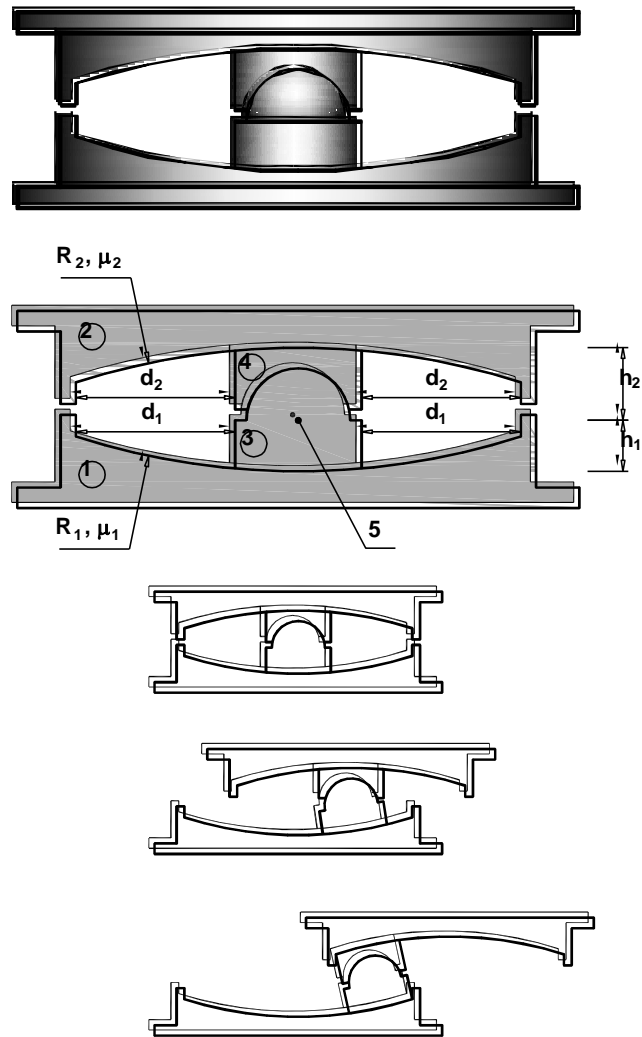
Общий вид и схема поведения двухмятниковой опоры:
